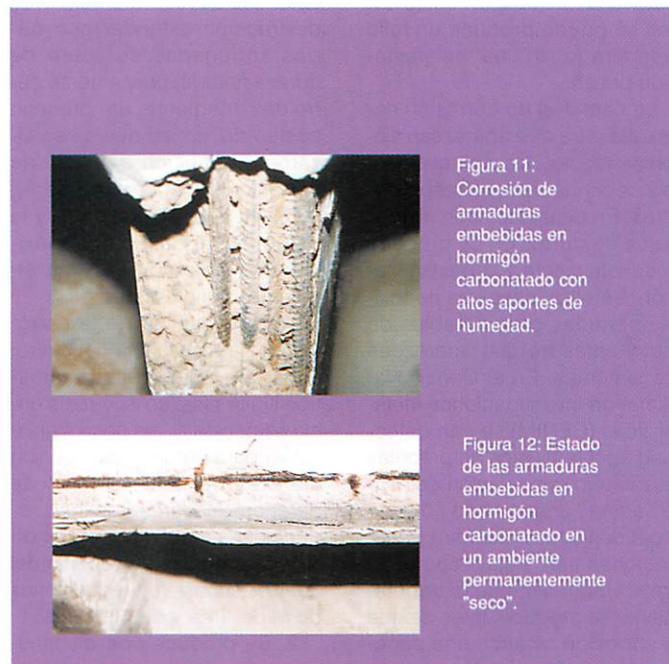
Corrosión de armaduras embebidas en hormigón carbonatado con altos aportes de humedad.
